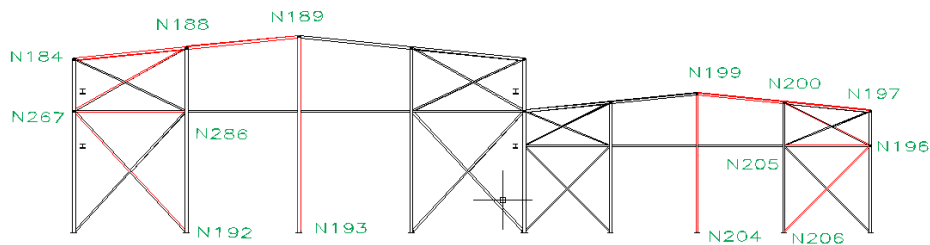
Barras comprobadas en el pórtico de fachada (alineación A)
